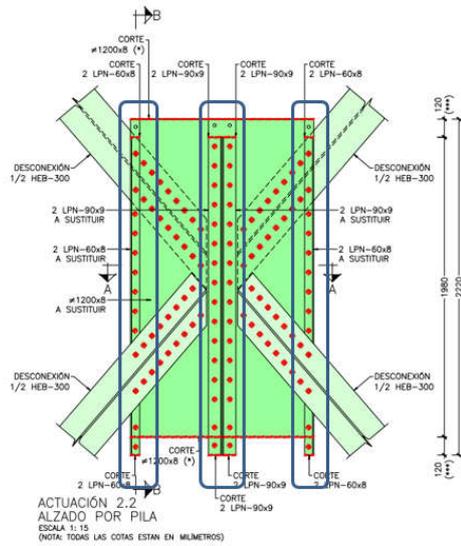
Nudo intermedio mamparo de pila. Retirada de angulares
